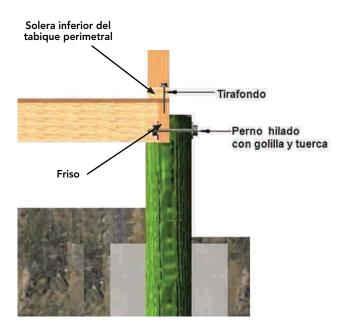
23: Corte intermedio de viga perimetral del entramado horizontal, se fija a cada pilote mediante perno hilado con golillas y tuerca, cuyas dimensiones las determina el cálculo. Normalmente son de un diámetro mínimo de 12 mm y largo de 7" a 8" (170 a 200 mm). Solera inferior del tabique perimetral se fija al friso mediante tirafondos cada 0,40 m, definidos según cálculo.
